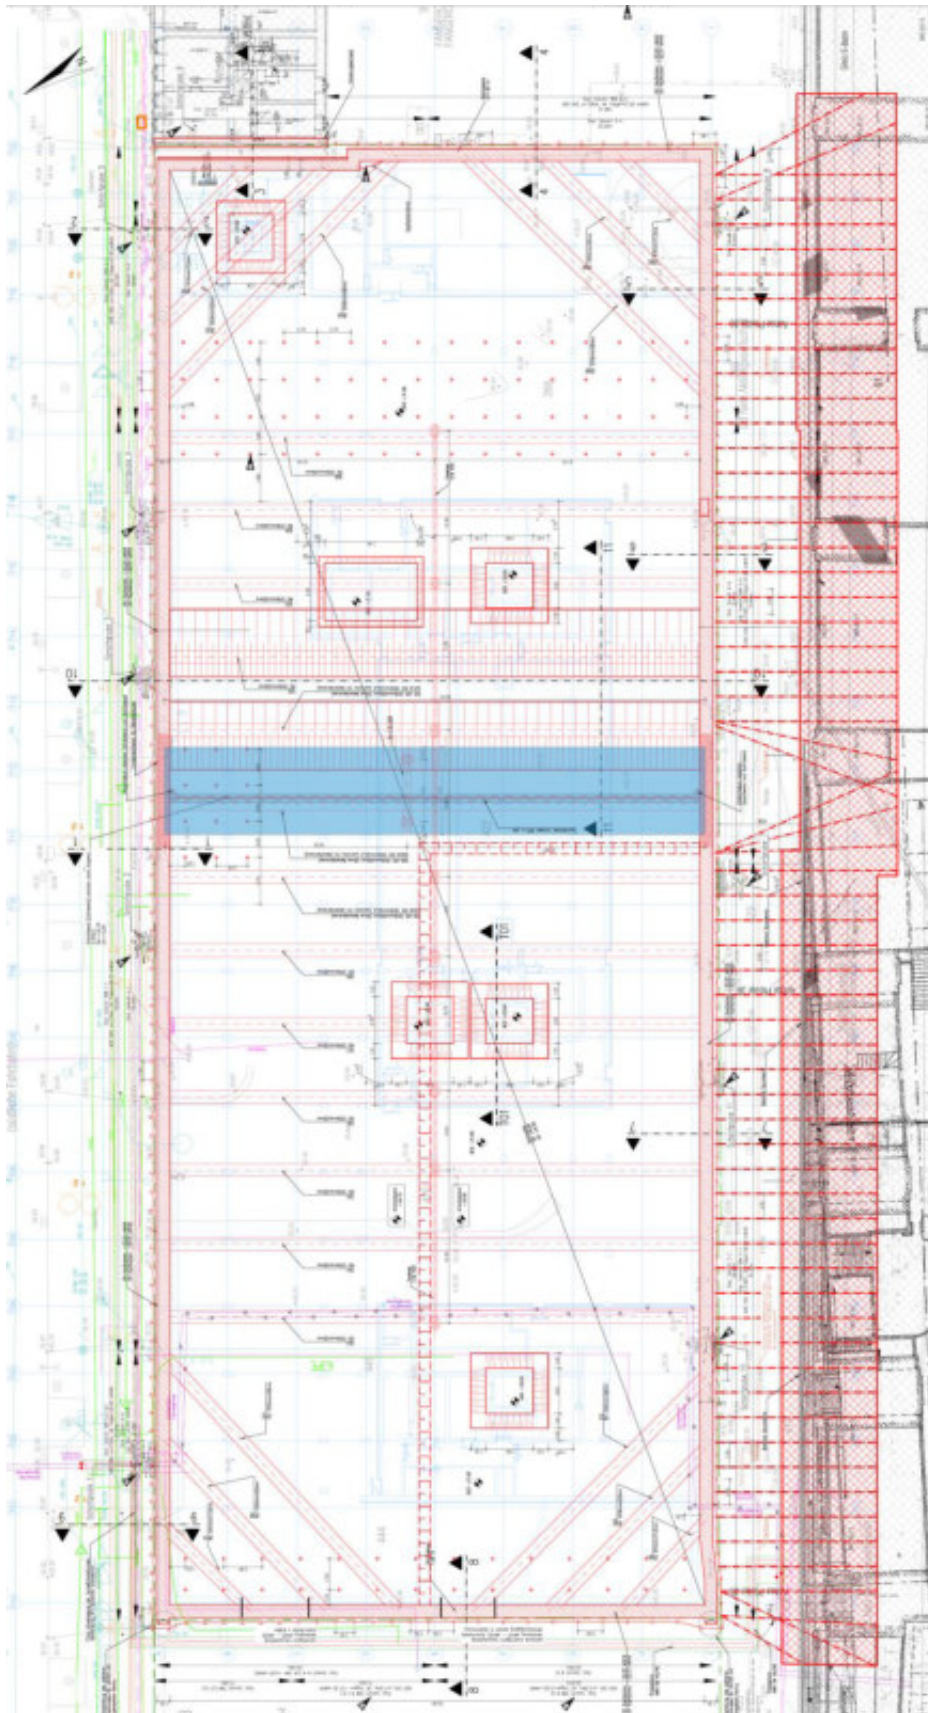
Grundriss Baugrube JAH0 1 aus [S 5]
